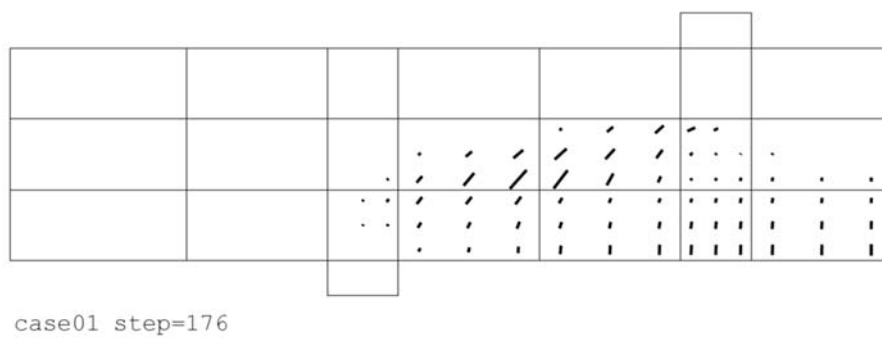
破壊時の変形及びひび割れ状態 (CaseNo. 1)
